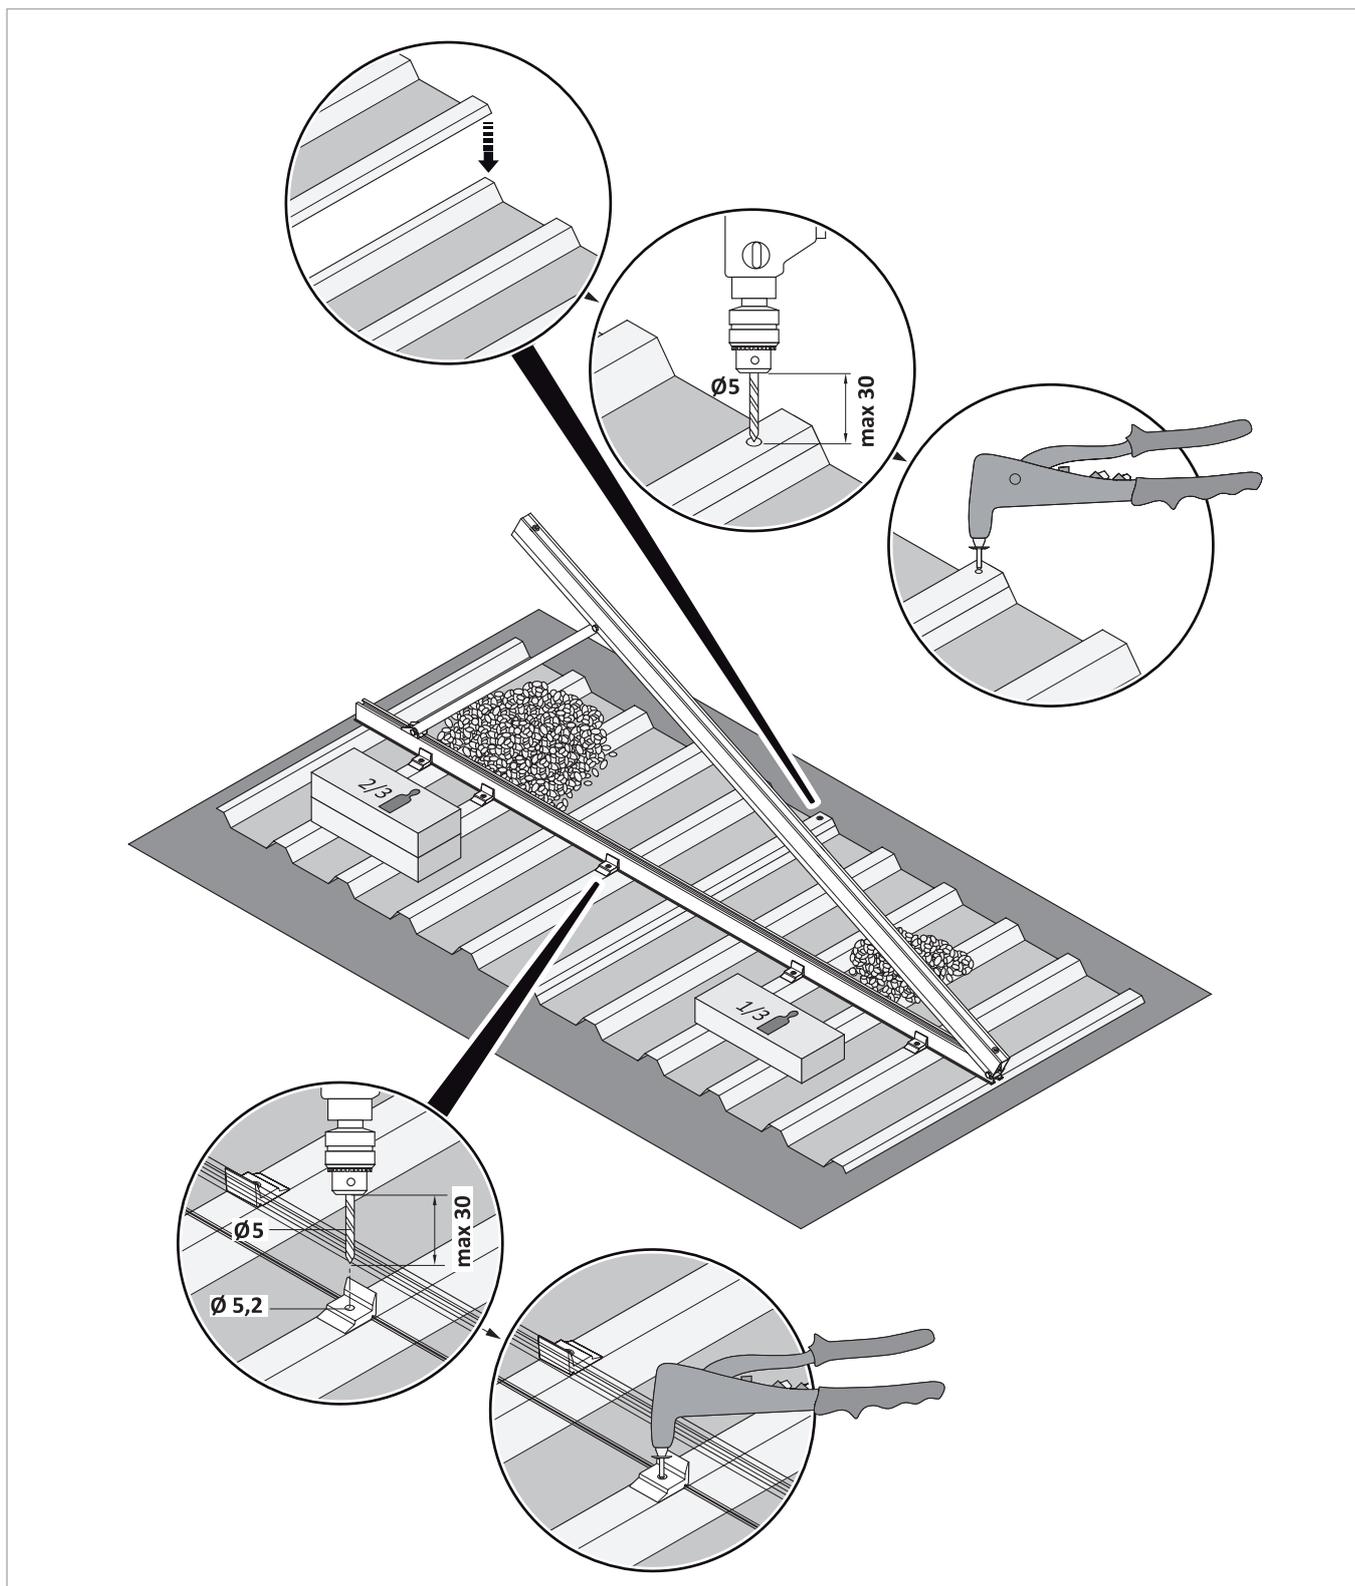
montaggio del supporto per tetto piano su lamiera trapezoidale
